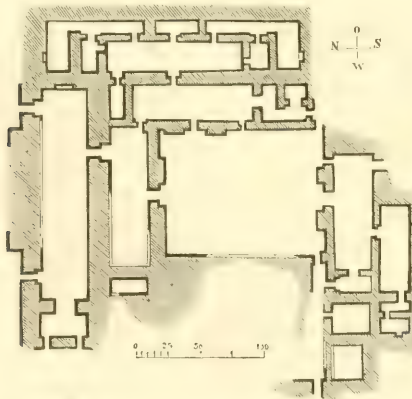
Nordwestpalast von Nimrud (Grundriss).
